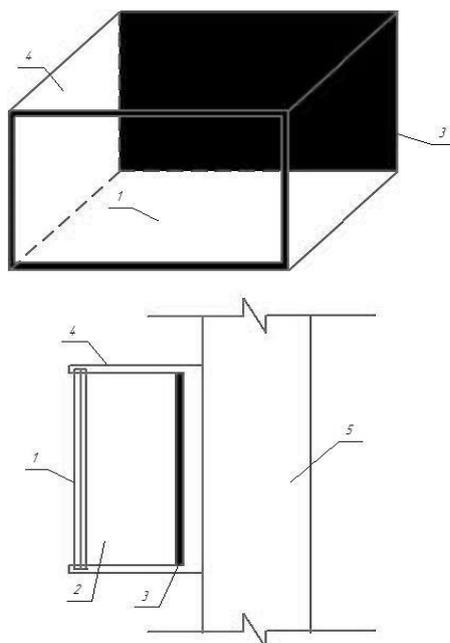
Стеновой блок: 1- Стеклопакет; 2 -Воздушная прослойка; 3 - Внутренняя стенка стеклобетона, окрашенная в черный цвет; 4 - Бетонный блок; 5 - Наружное ограждение здание
